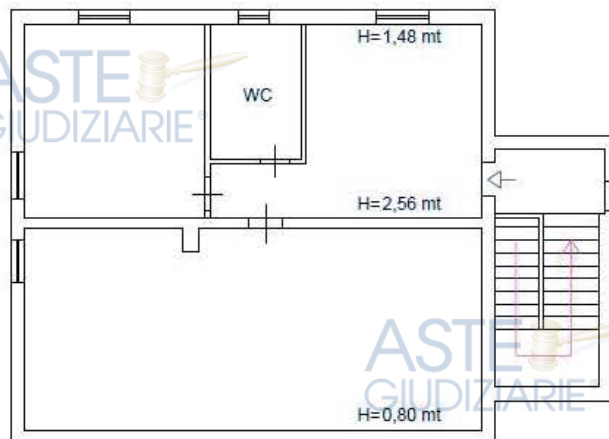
PLANIMETRIA SOTTOTETTO REDATTA DAL CTU - IN ALLEGATO
